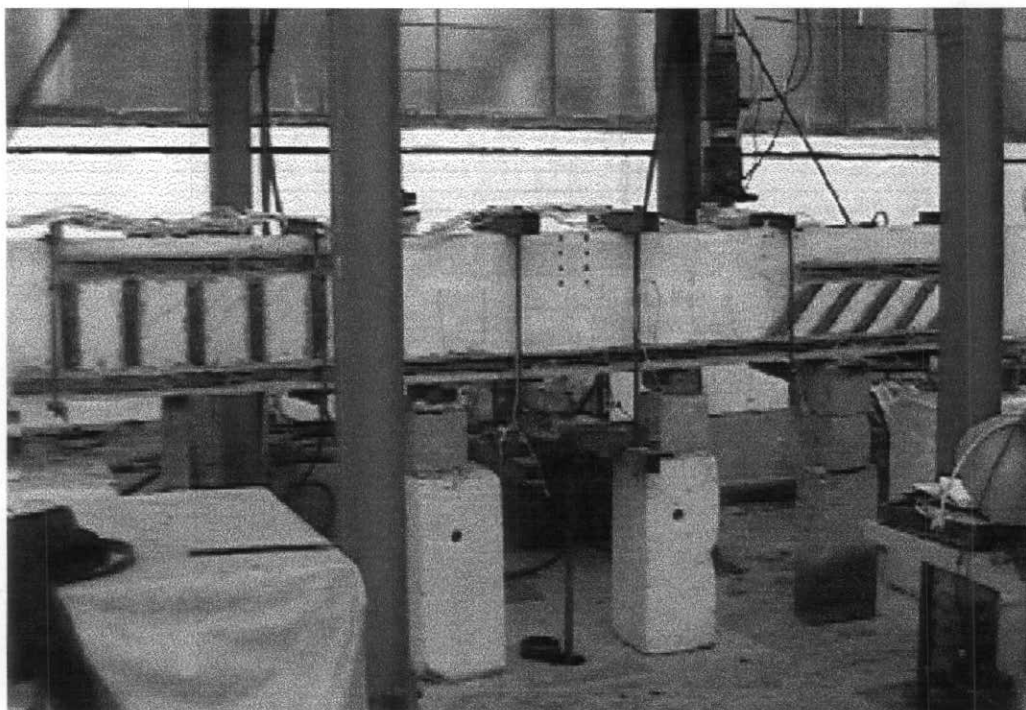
Viga reforçada submetida ao carregamento pelo esquema de tirantes–V5.
